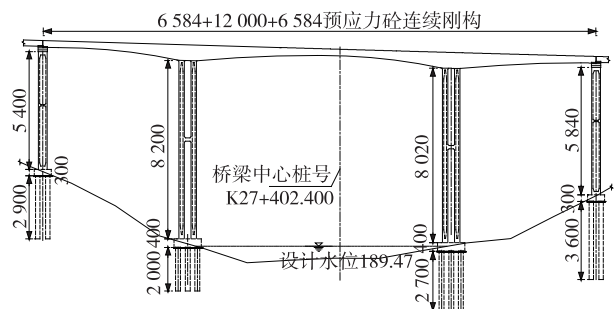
桥梁立面布置(单位: 标高为 m, 其他为 cm)
